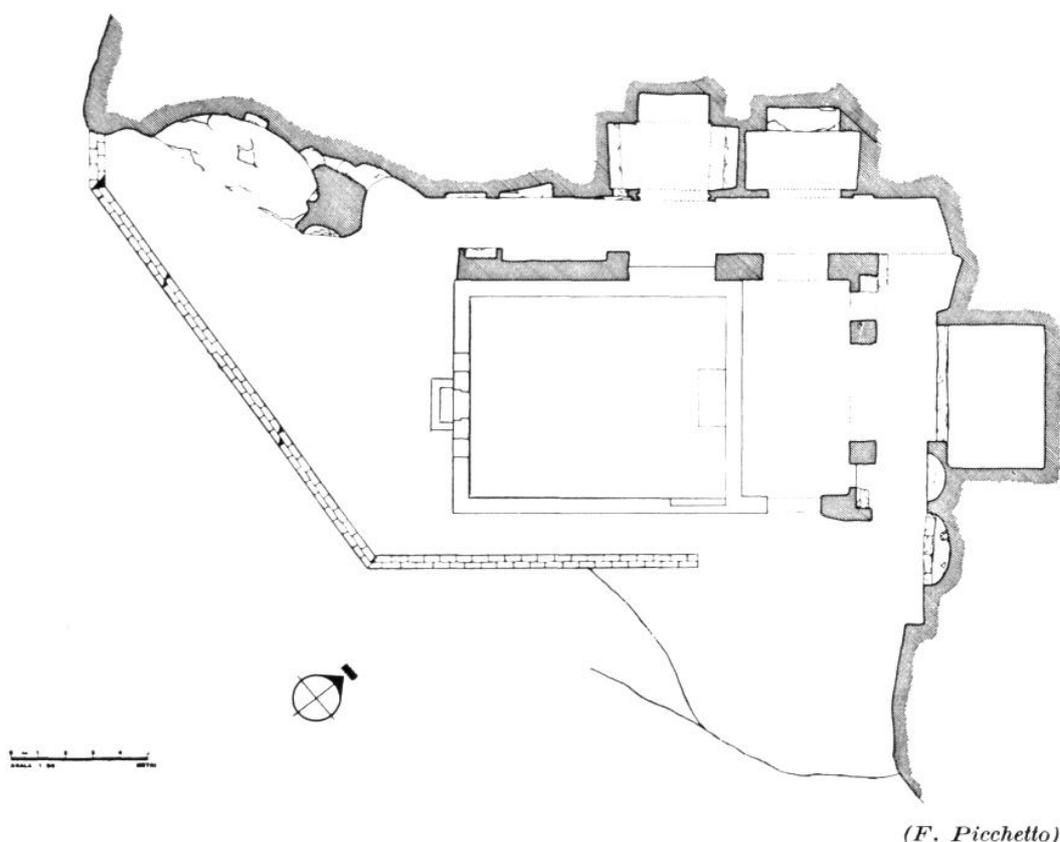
SUTRI, CHIESA RUPESTRE DI SANTA FORTUNATA, PIANTA.
